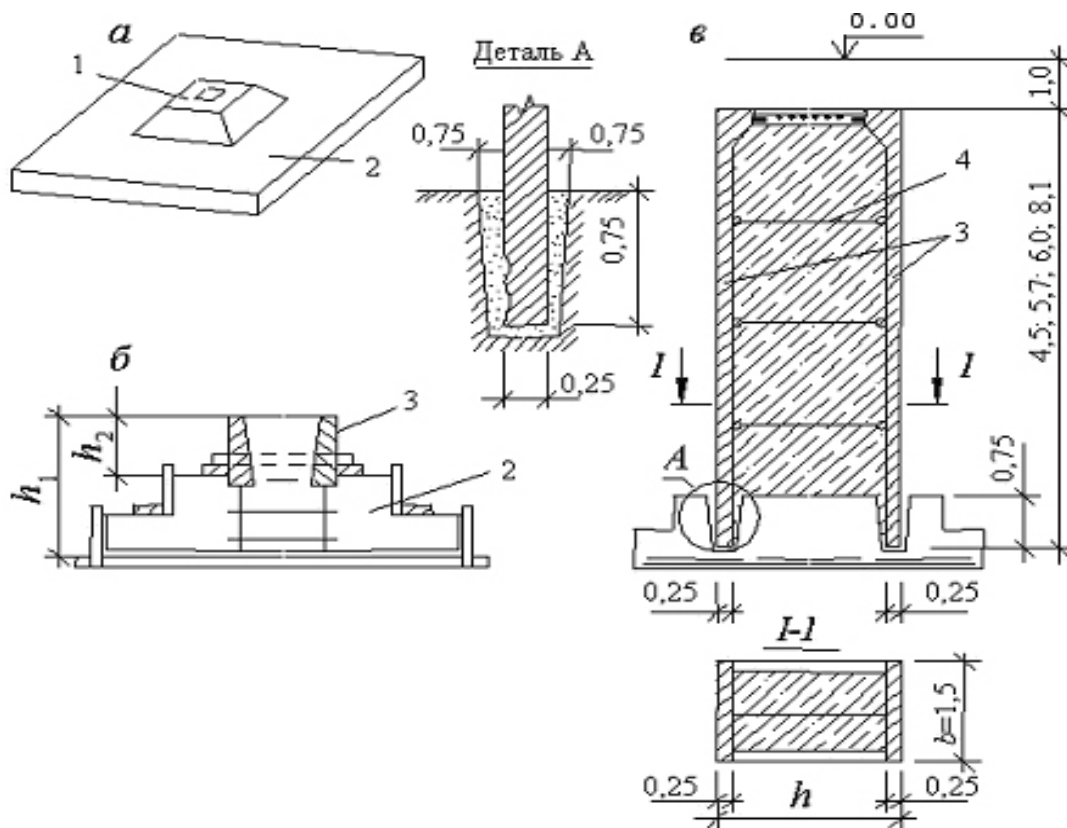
Збірно-монолітні фундаменти: *а* – для збірних колон будівлі зі зв’язовим каркасом; *б* – для збірних колон одноповерхових промислових будівель; *в* – для сталевих колон промислової будівлі;
